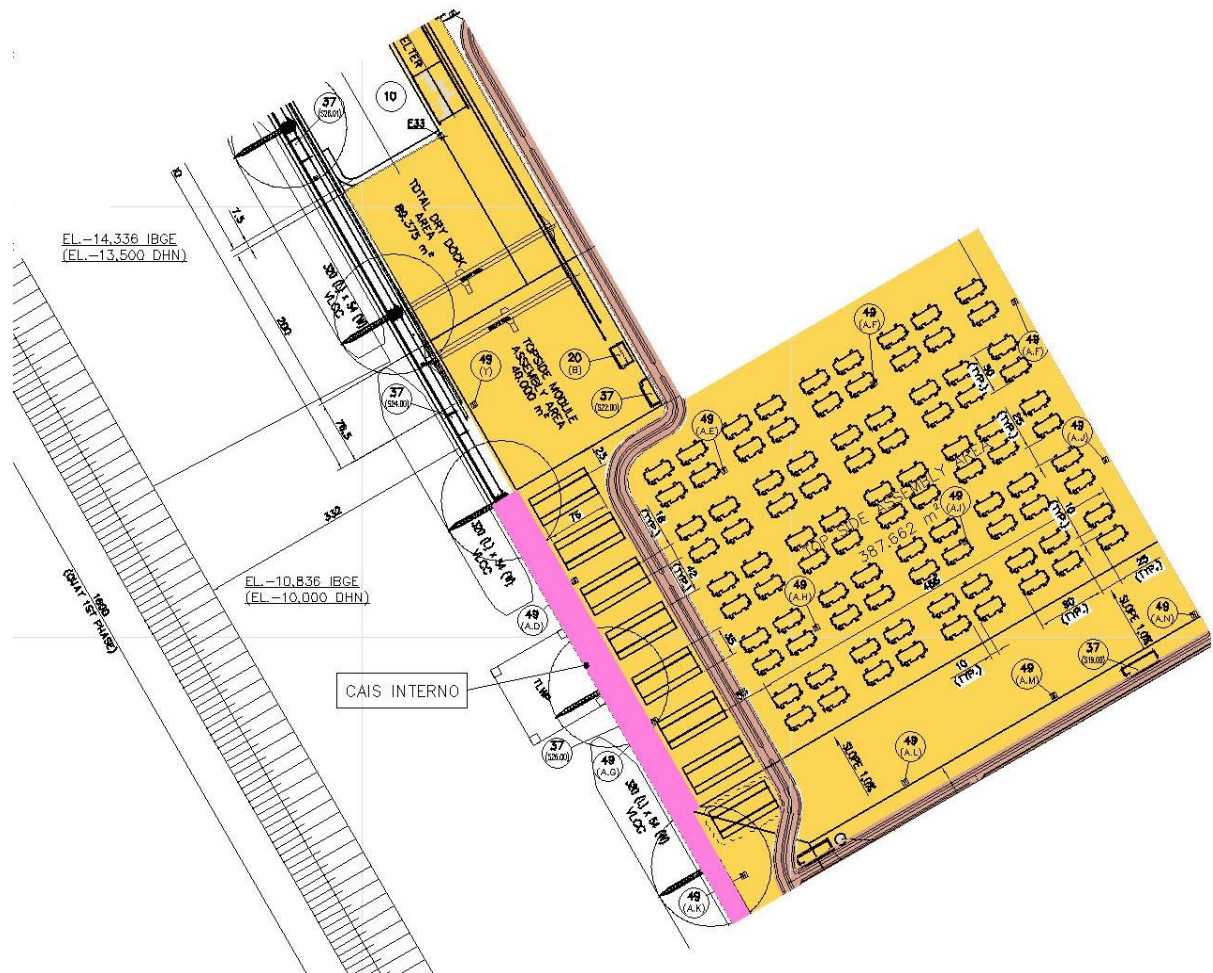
Planta de pavimentação da área de montagem de módulos. Fonte: Projeto OSX
